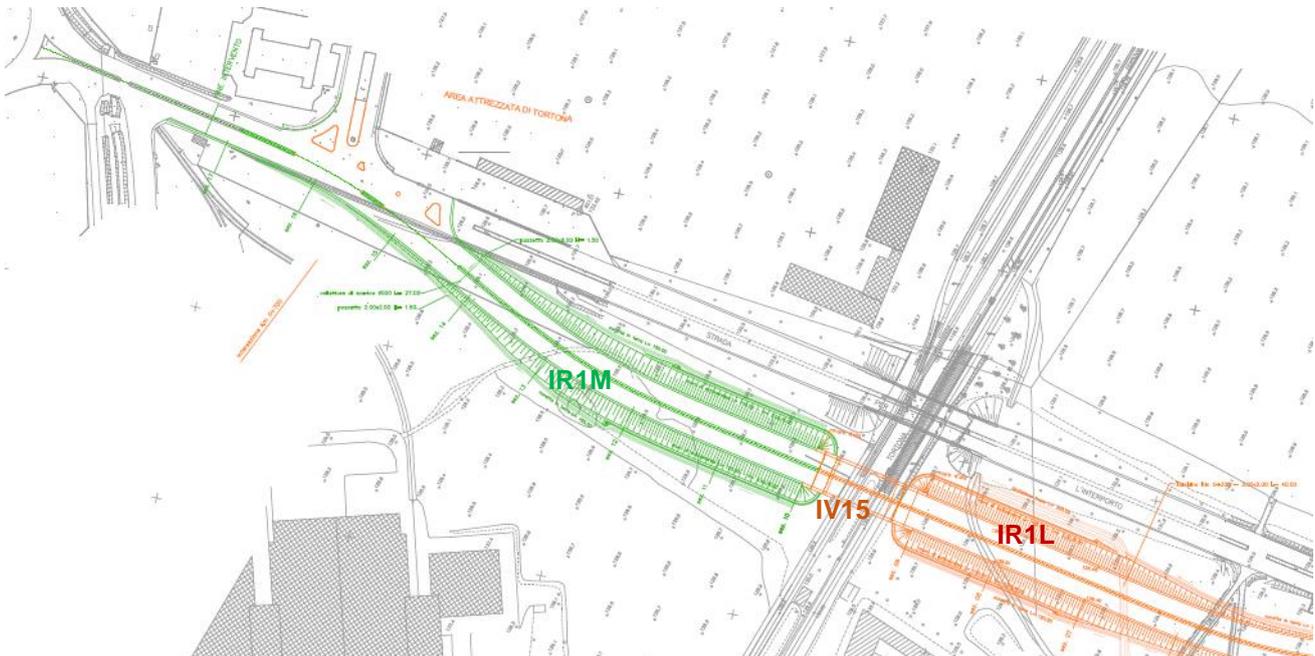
Localizzazione della rampa di approccio IR1M nel progetto approvato (in colore verde)
